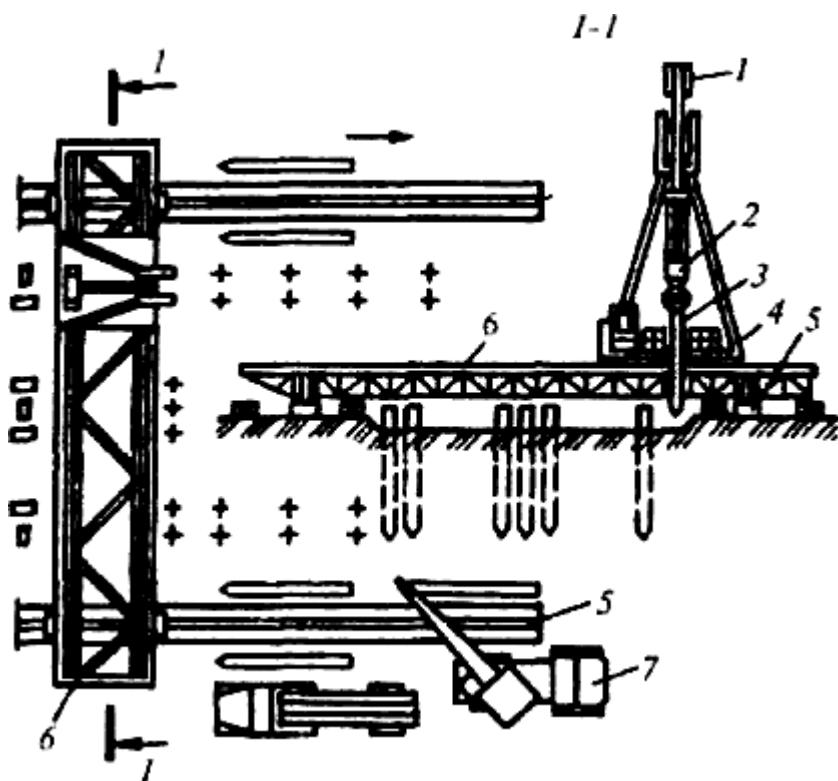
Схема погружения свай мостовой сваебойной установкой:
